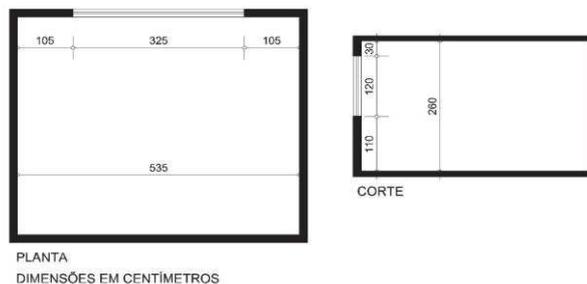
Planta e corte com dimensões da sala do modelo da ZCBH.
